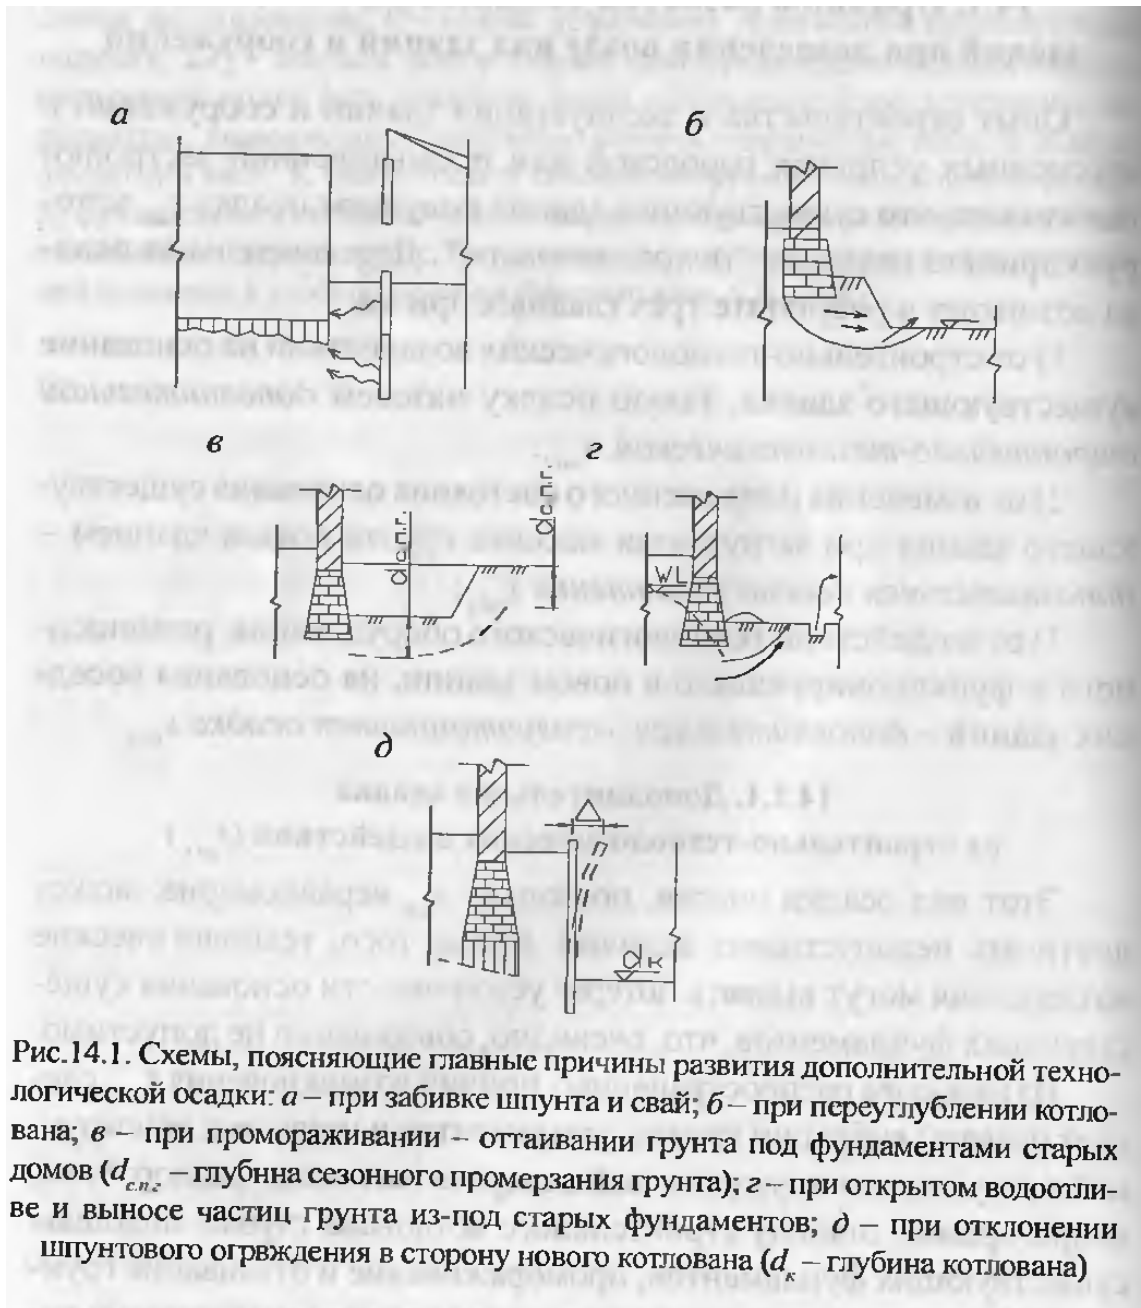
Схемы, поясняющие главные причины развития дополнительной технологической осадки: а – при забивке шпунта и свай; б – при переуглублении котлована; в – при промораживании – оттаивании грунта под фундаментами старых домов ($d_{с.н.з.}$ – глубина сезонного промерзания грунта); г – при открытом водоотливе и выносе частиц грунта из-под старых фундаментов; д – при отклонении шпунтового ограждения в сторону нового котлована ($d_к$ – глубина котлована)
